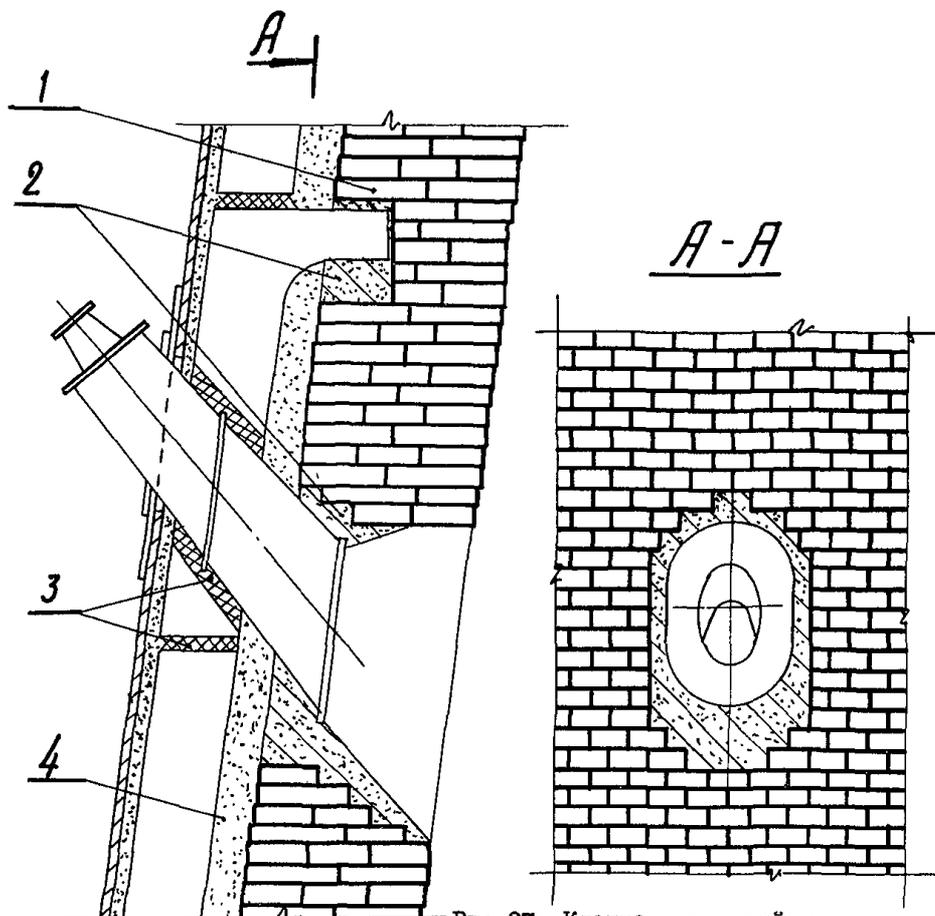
Кладка отверстий для установки устройств для измерения статического давления газа в шахте:
